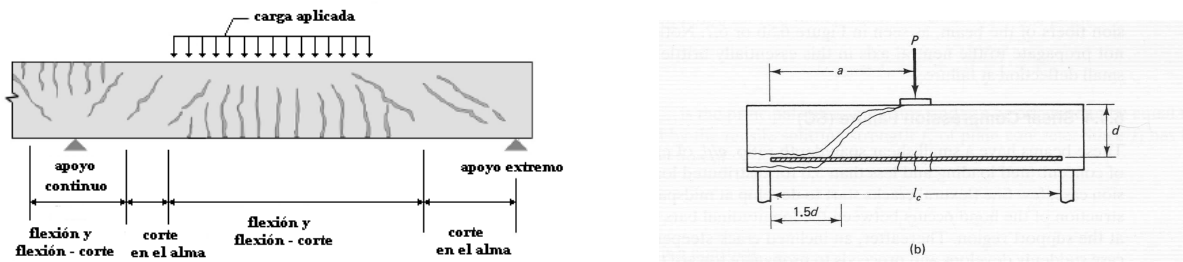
Tipos de fisuración en vigas de hormigón armado, a la izquierda con cargas distribuida y a la derecha con carga concentrada para  $2.5 < a/d < 5.5$ .
